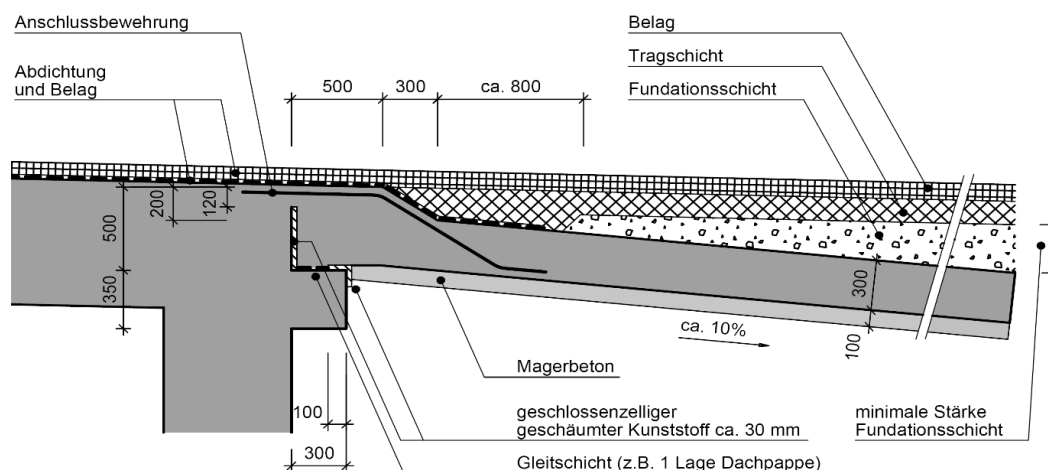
Schleppplattenausführung für integrale Brücken laut [1]
